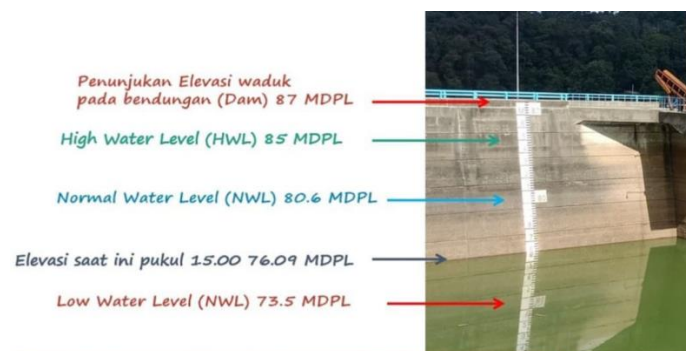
Bendungan ULPLTA Koto Panjang
